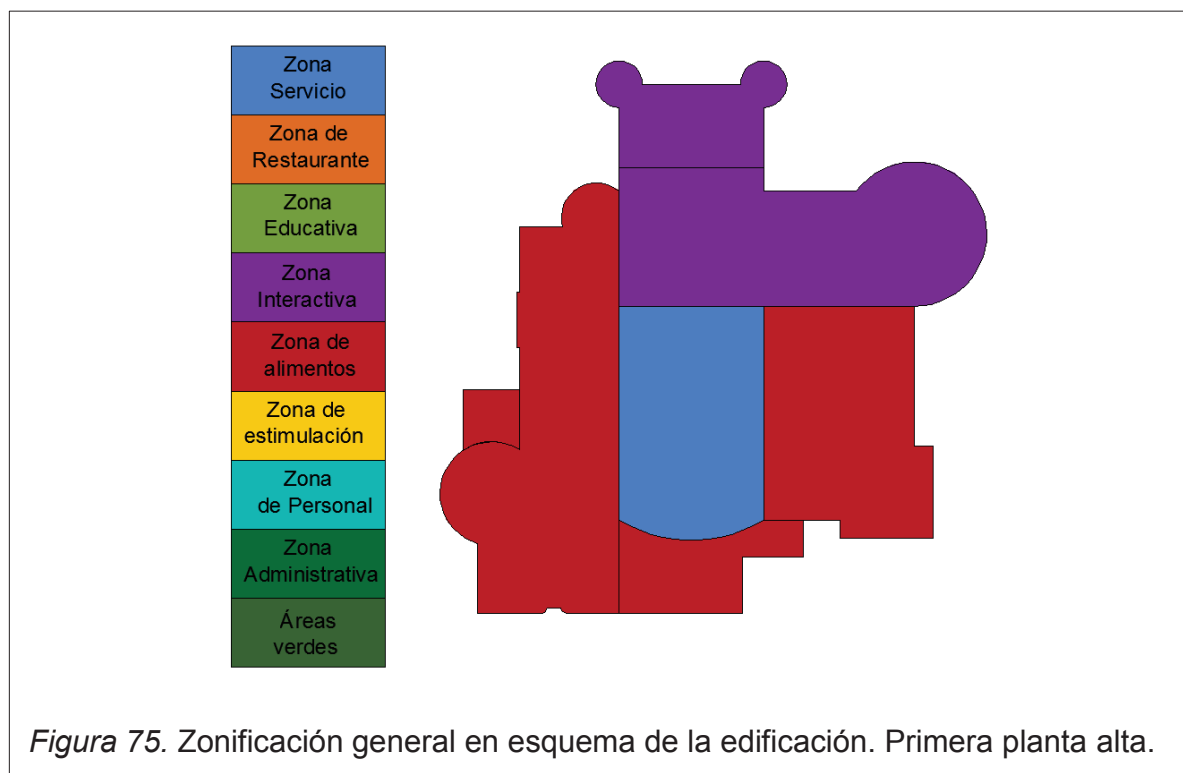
Zonificación general en esquema de la edificación. Primera planta alta.
